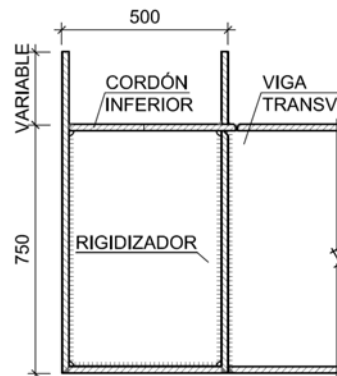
Detalle de conexión entre viga transversal y cordón inferior
